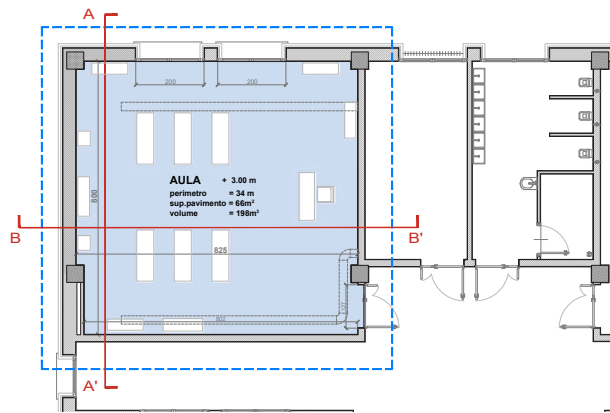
22 – Pianta dell'aula oggetto di studio.
